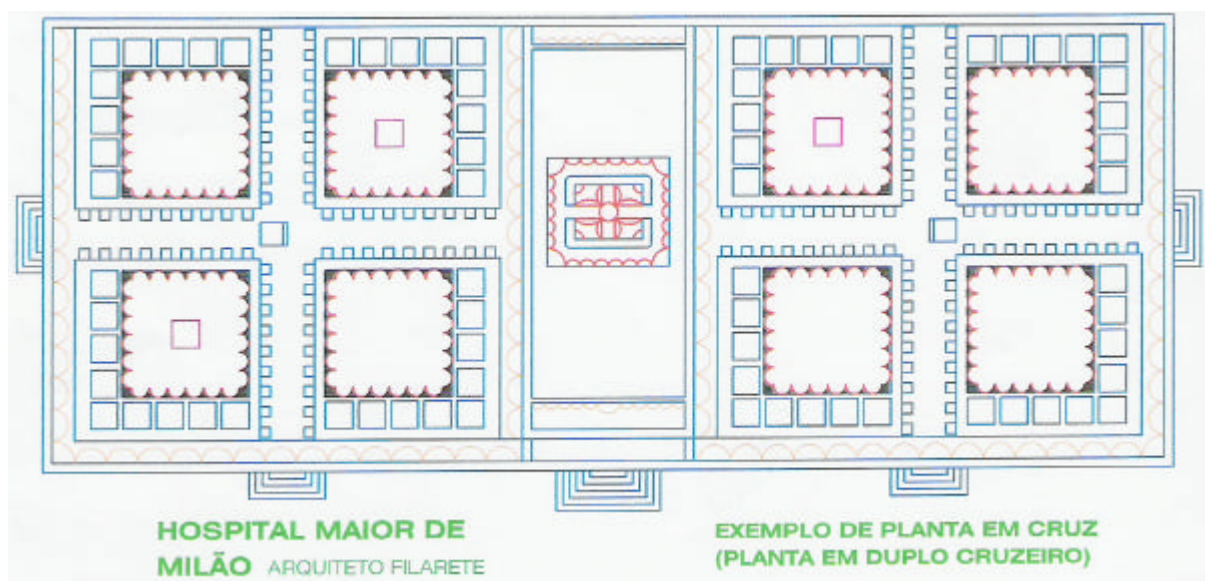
PLANTA esquemática do HOSPITAL MAIOR de MILÃO - ARQUITETO “FILARETE” - 1456.
